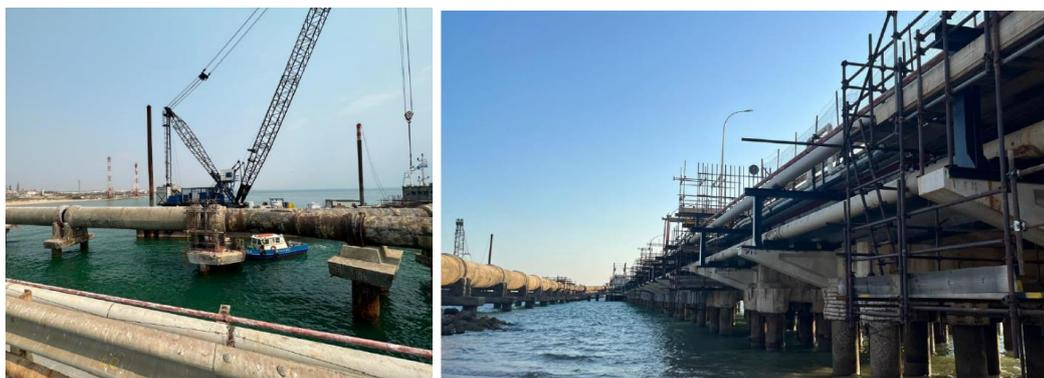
Area di interesse in cui si prevede l'installazione della tubazione temporanea aerea di collegamento e lo sfruttamento delle strutture pontile
